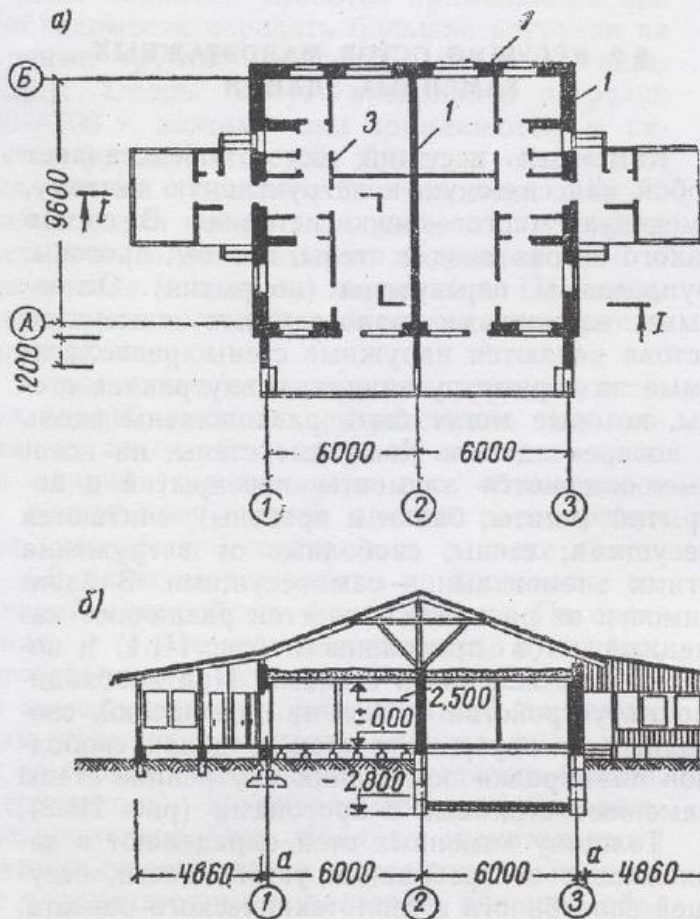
Малоэтажное каменное здание с продольными несущими стенами
